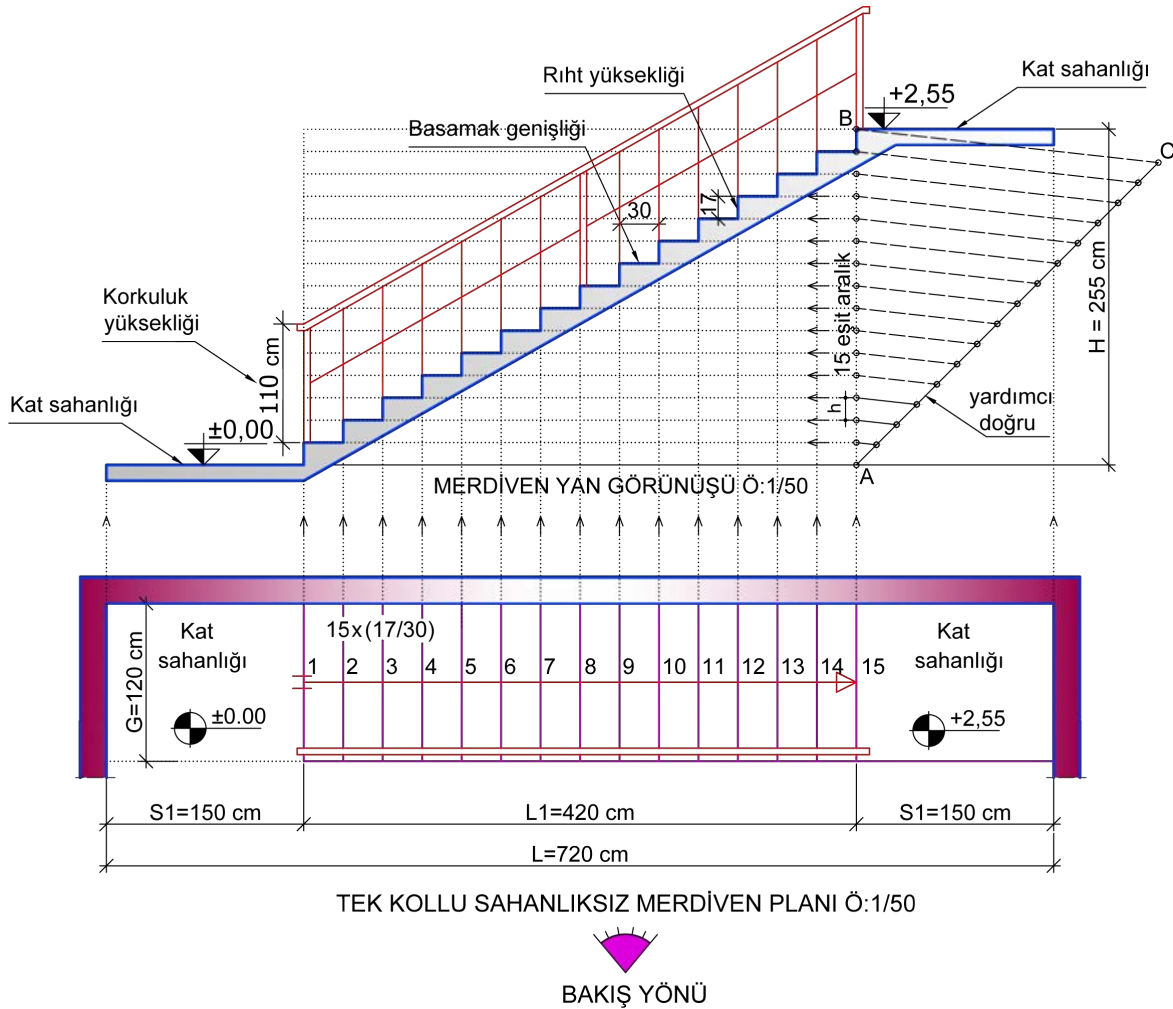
a) Tek kollu sahanlıksız merdiven taslak dengelendirme plan çizimi
